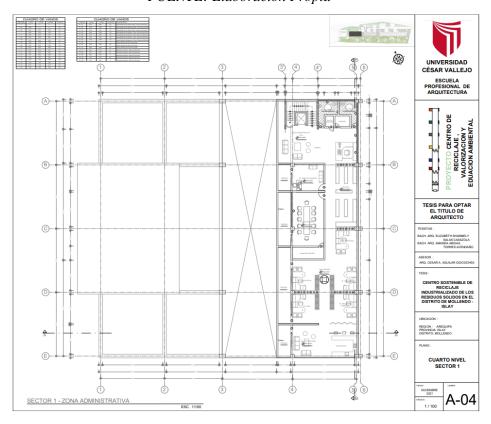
Planta de Distribución, Sector 1 – Cuarto Nivel FUENTE: Elaboración Propia
